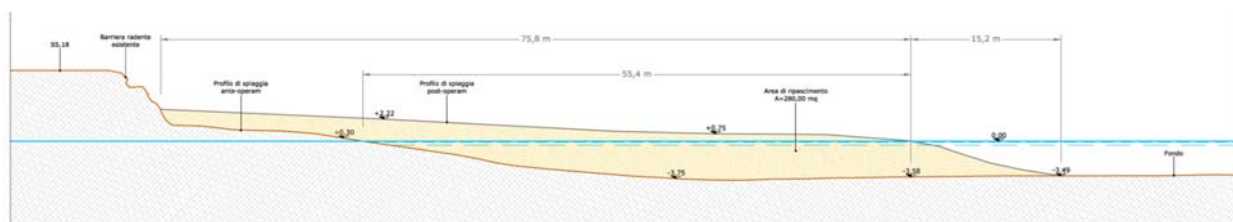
Intervento B: Sezione tipo di ripascimento
